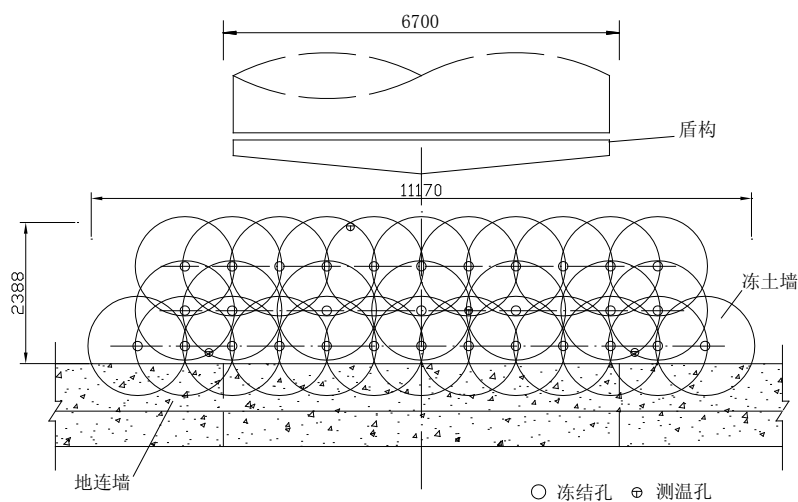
冰冻法进洞冻结孔平面布置图
